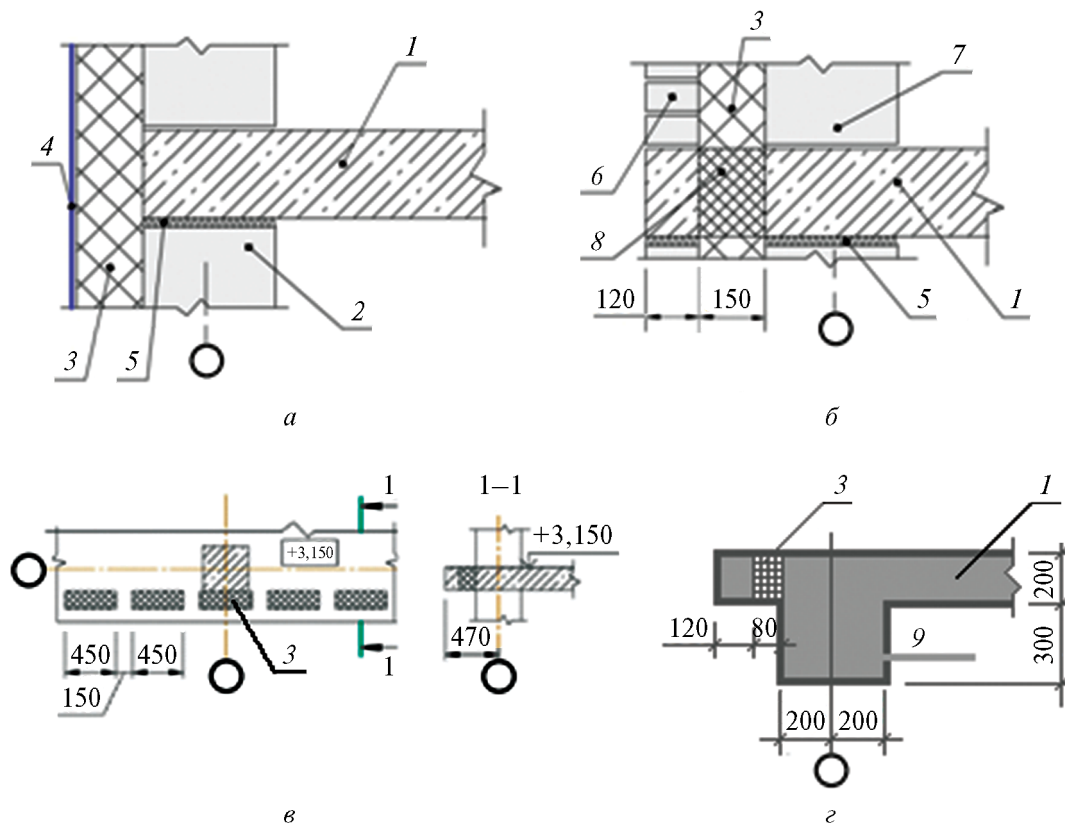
Конструктивное решение многослойных наружных стен, установленных на перекрытие здания:
